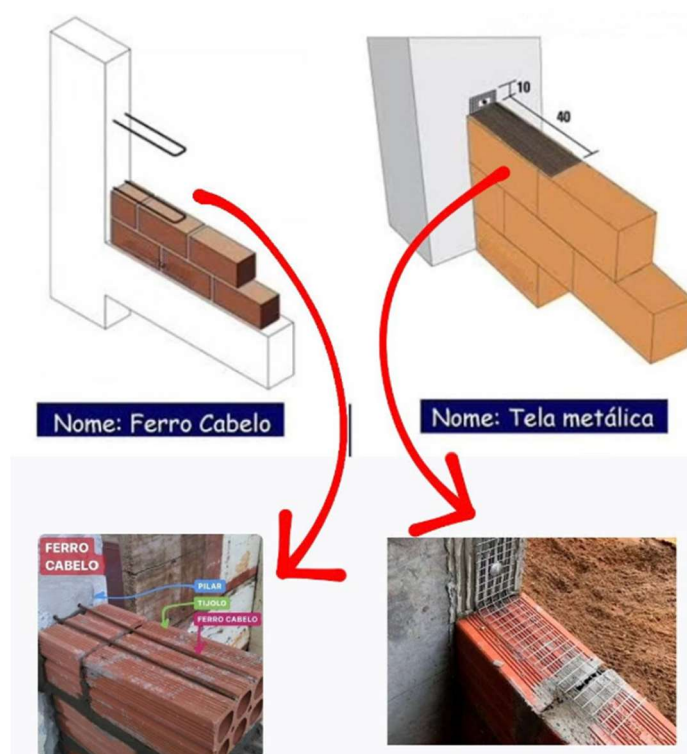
Especificações e dimensões do “ferro cabelo” OU tela soldável para engaste de alvenaria
